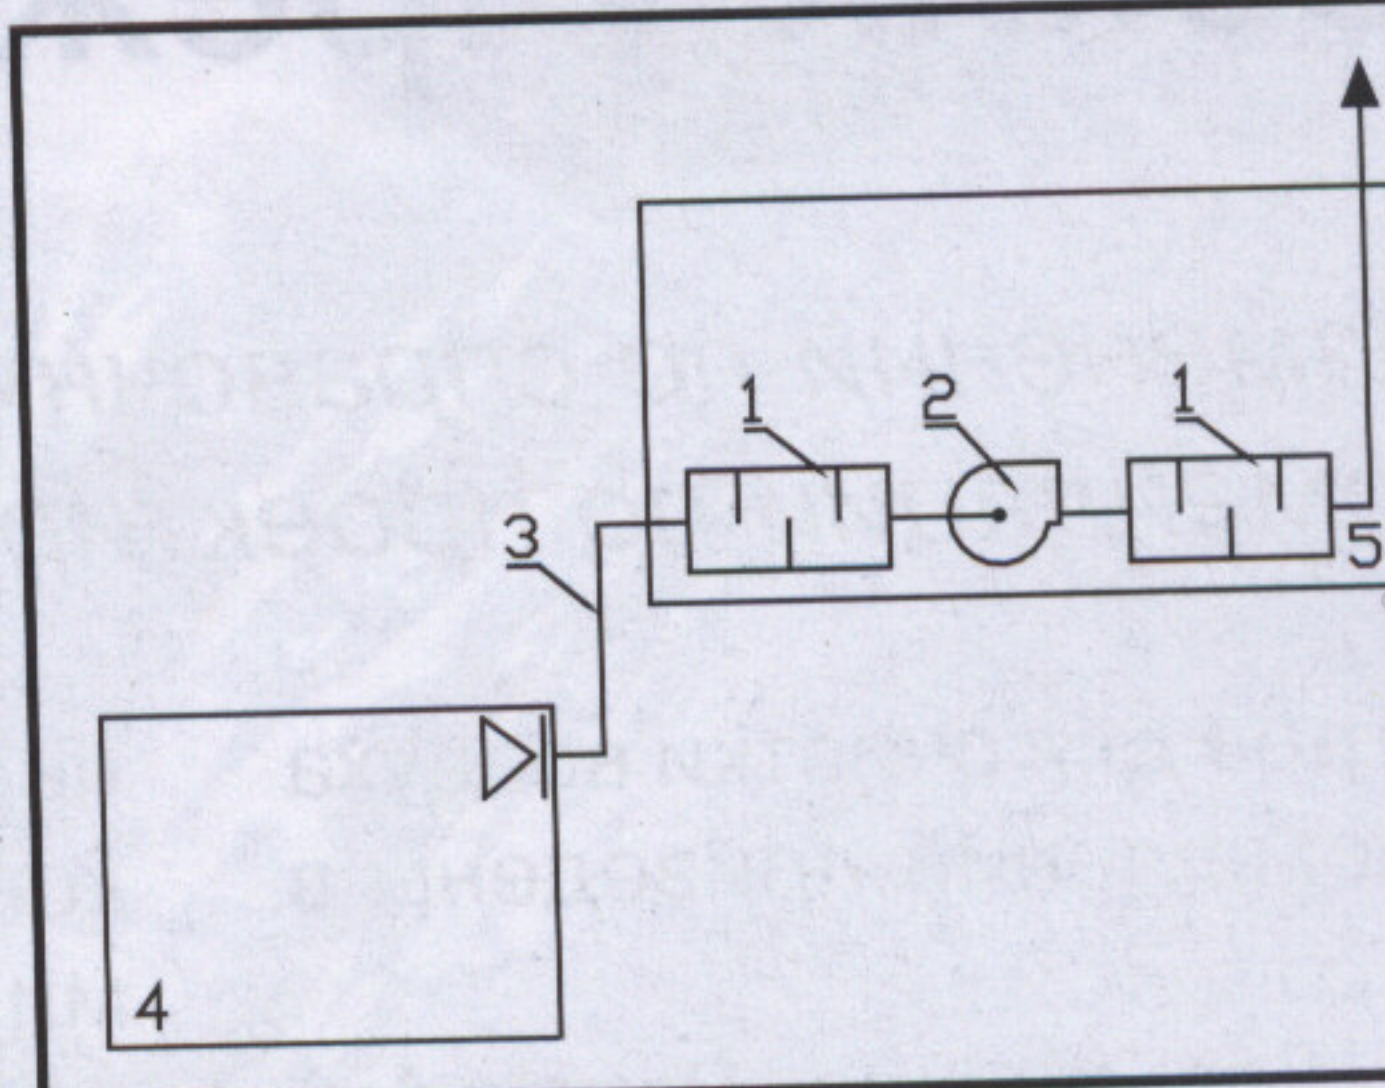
Схема установки шумоглушителя на вытяжном воздуховоде до и после вентилятора
